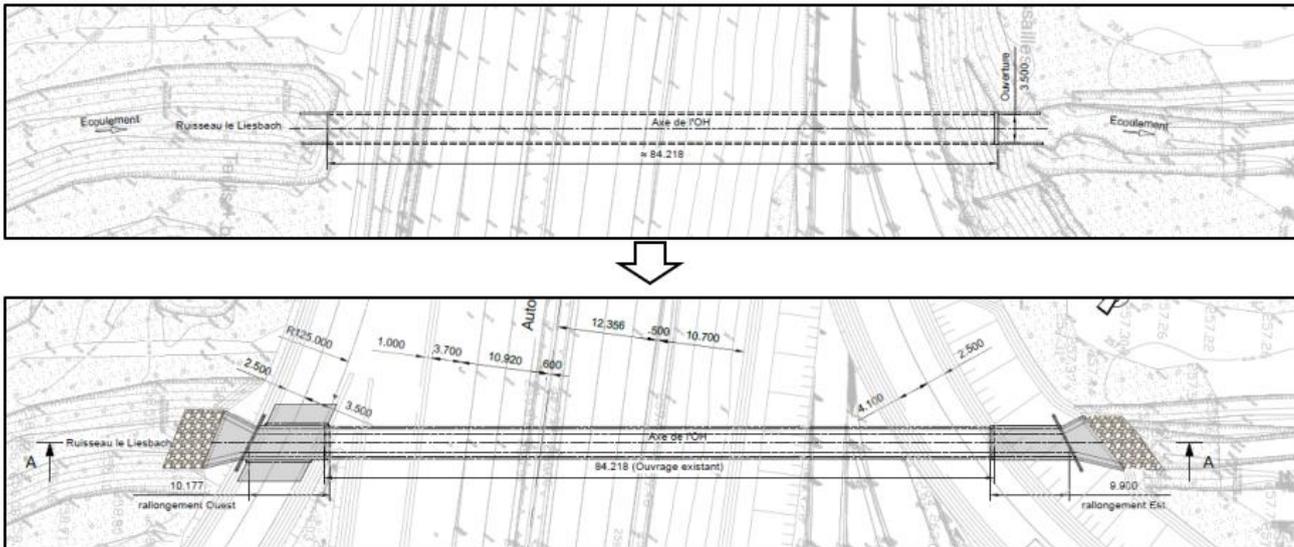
Vues en plan de l'ouvrage existant et ouvrage projet (Source : AEU 5A3F)
